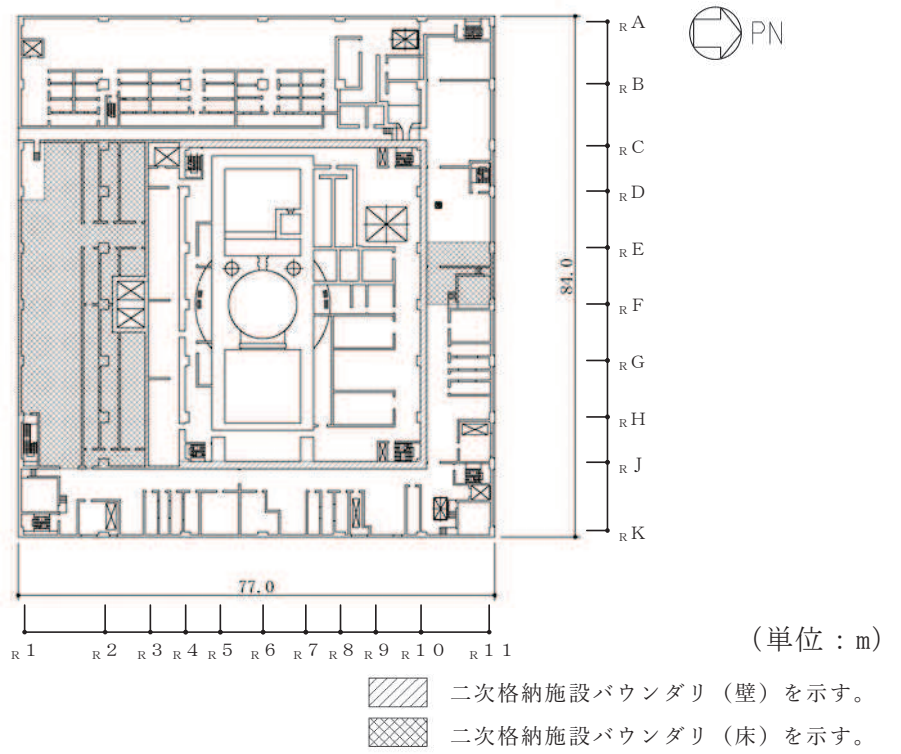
原子炉建屋原子炉棟（二次格納施設）の範囲の平面図
